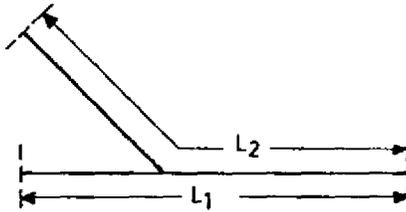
Longitud de las secciones de las alcantarillas
